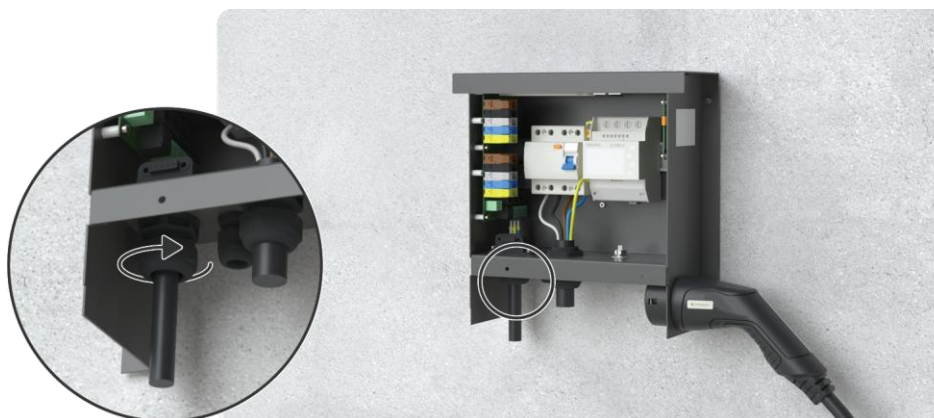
Ziehen Sie die Kabelverschraubung fest.
